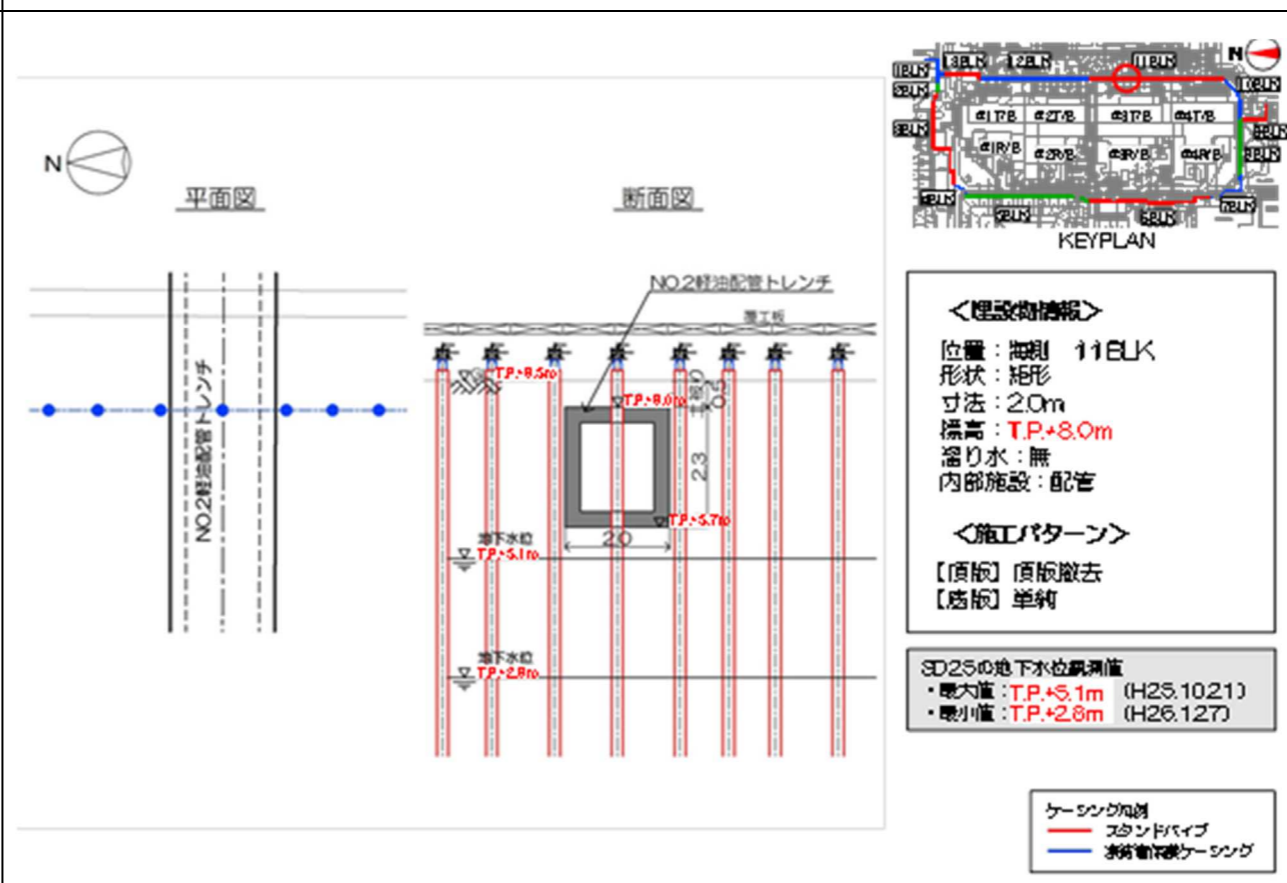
【11-12】3号機取水管-北①② 施工方法 (貫通施工)
